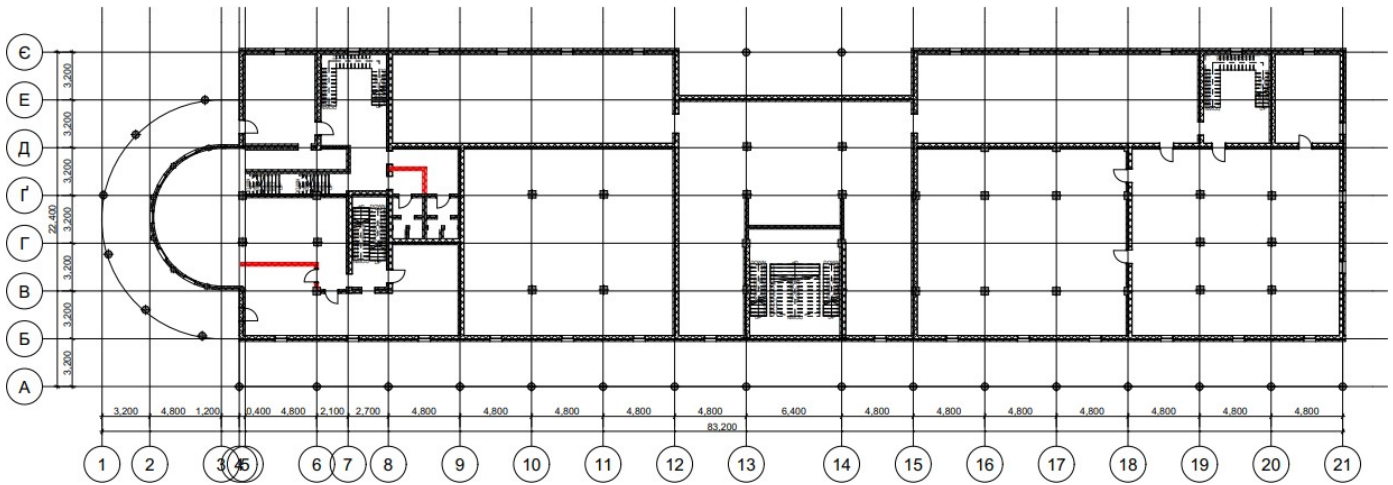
План 2 поверху з демонтажем стінових конструкцій
